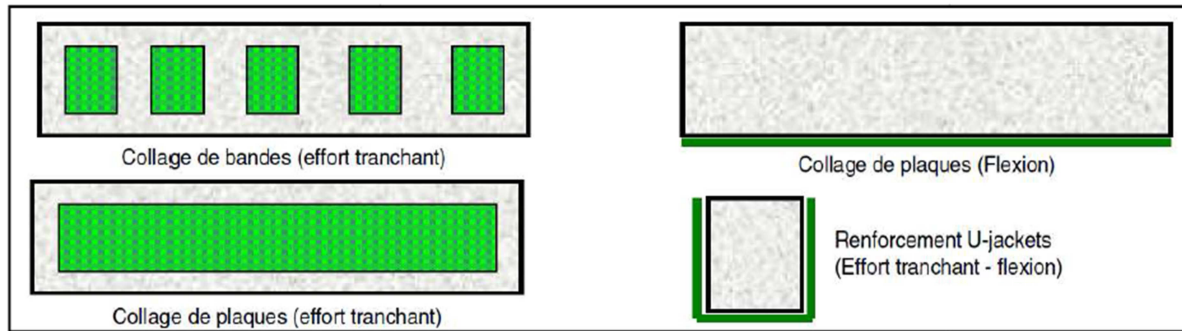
Renforcement des poutres par des matériaux composites [44]
